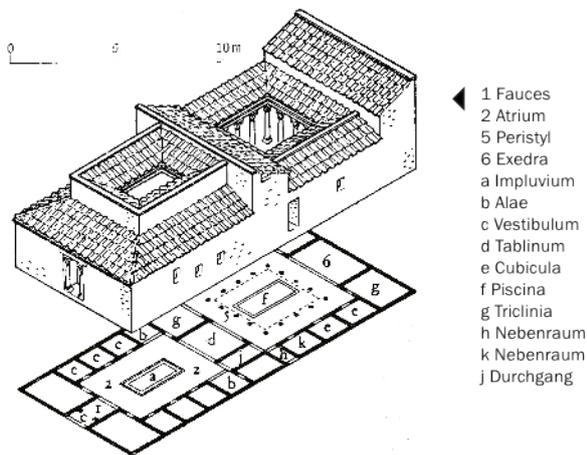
Domus, Axonometrie und Grundriss
